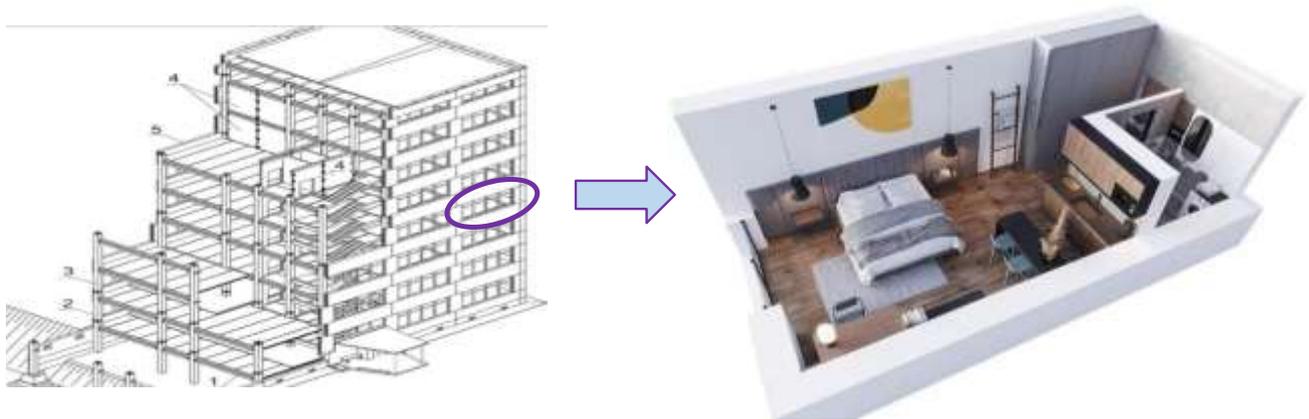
Схематизація перетворення багатоповерхових промислових будівель під доступне житло
